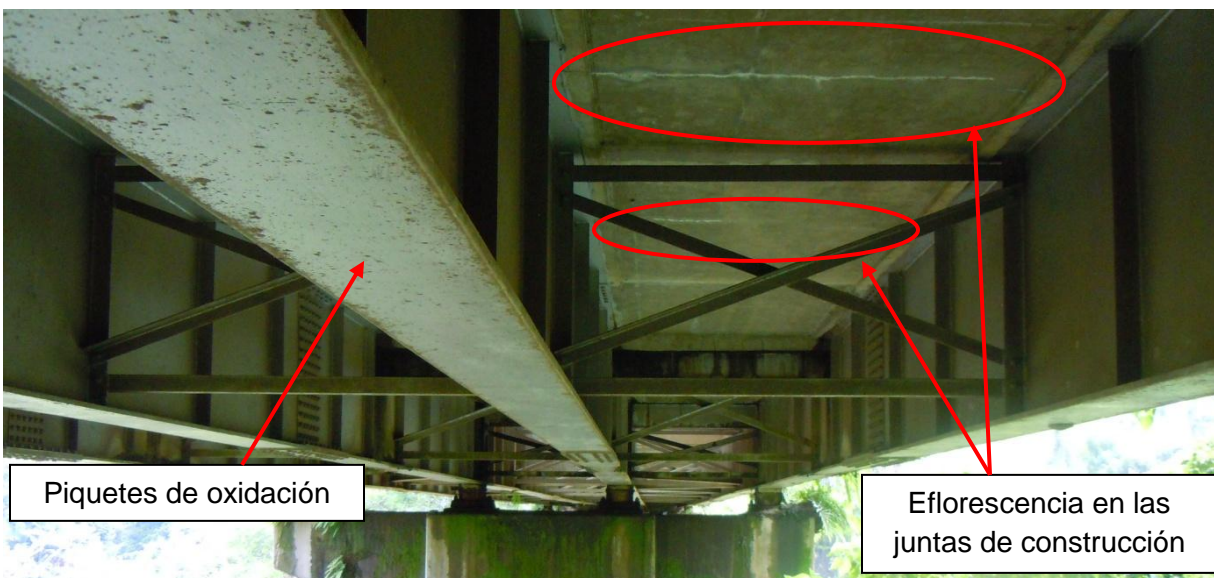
Juntas de construcción con eflorescencia en la parte inferior de la losa de la superestructura 3 y piquetes de corrosión en vigas principales (típico).
